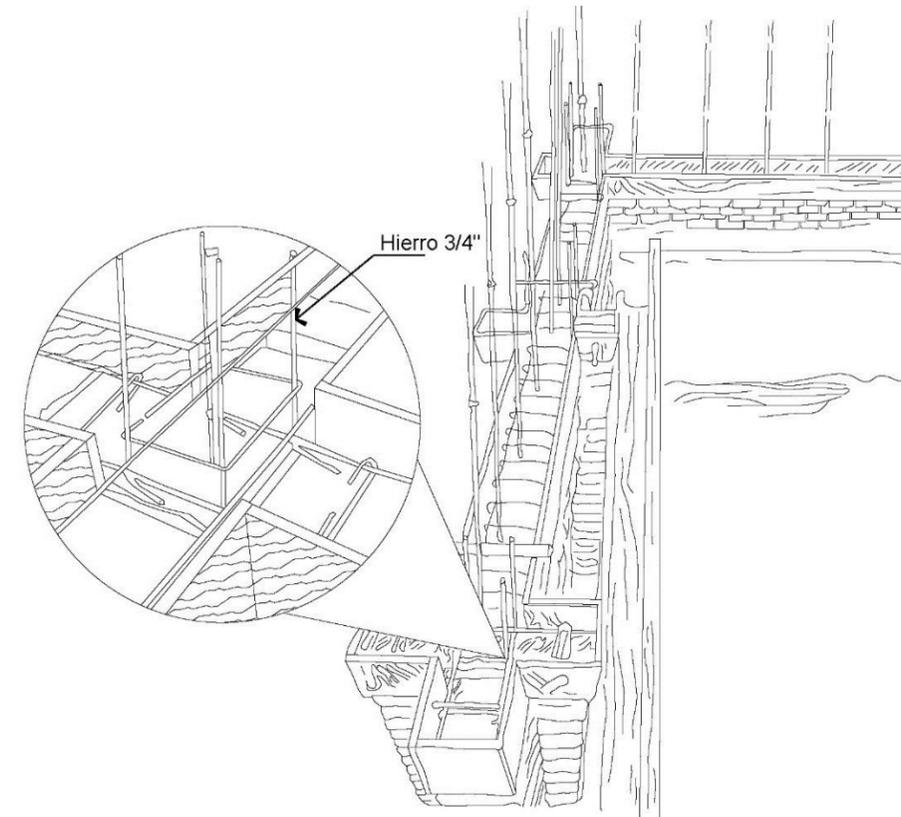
Colocación de viga de acero. Fuente: equipo de trabajo
